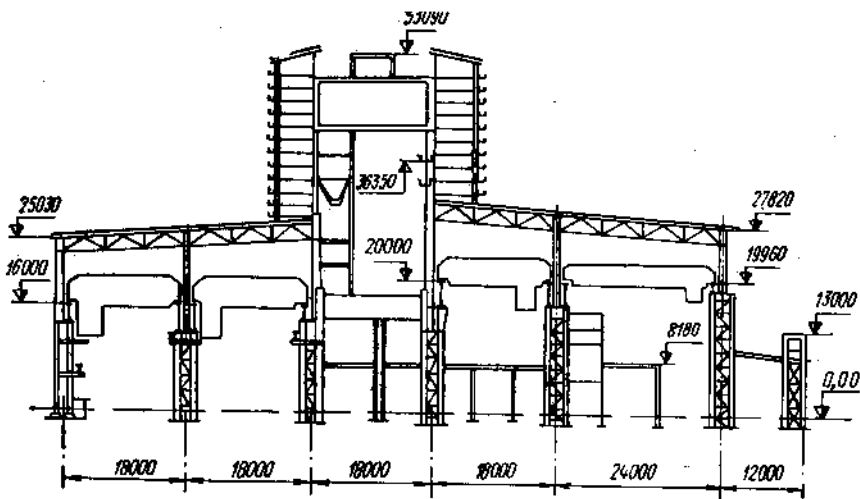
Разрез главного корпуса конверторного цеха Челябинского металлургического завода
